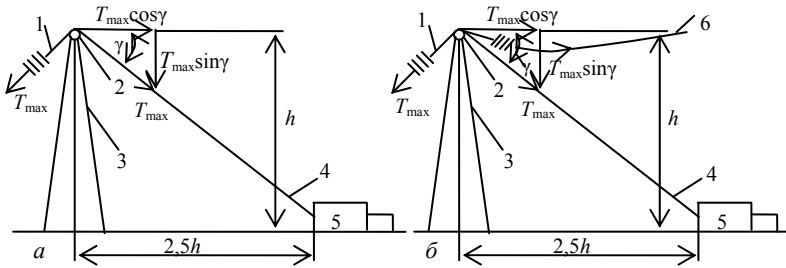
Схемы монтажа провода на анкерную опору:
